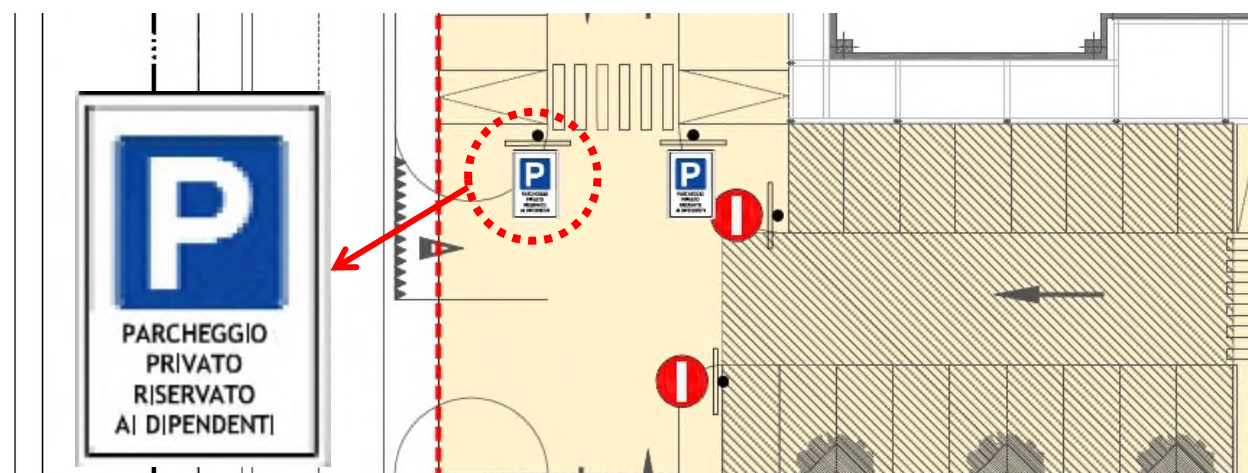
Ingresso park riservati ai dipendenti – zoom
